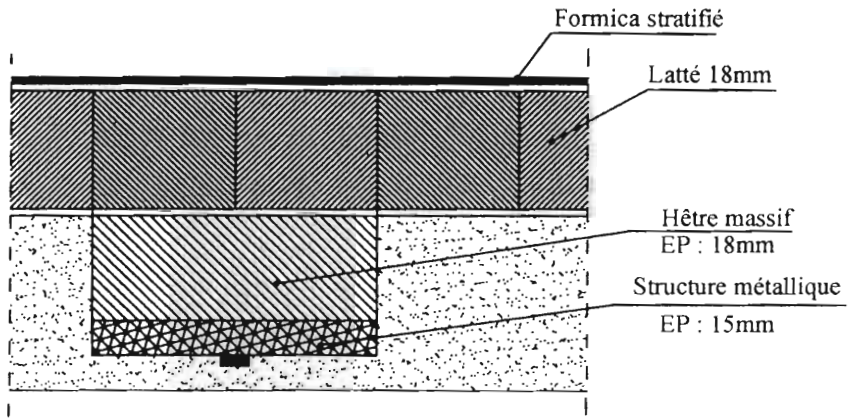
DETAIL DE LA PLANCHE DE TRAVAIL OU TOP
